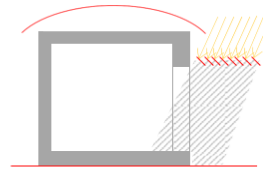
Sistema de persianas horizontales de protección solar. Fuente: Elaboración propia.
